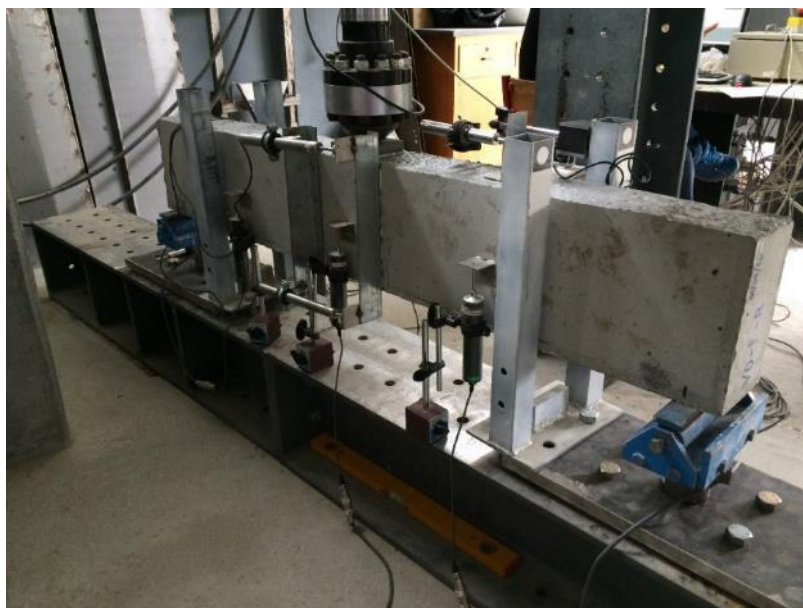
Viga para ensaio à flexão para a V0_F_REF
